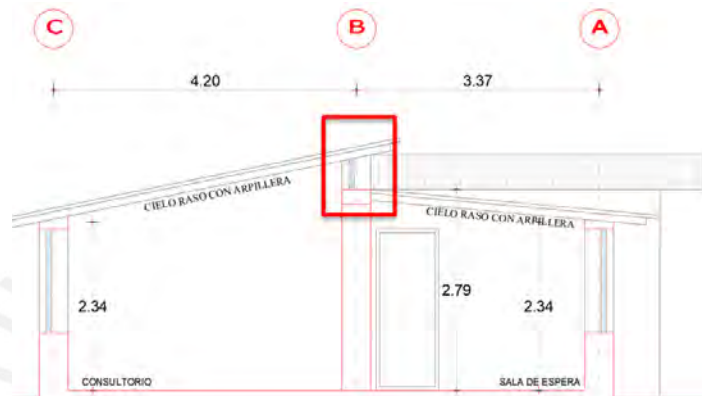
Ubicación de armado de vigas de madera en edificación de Pampacolca
